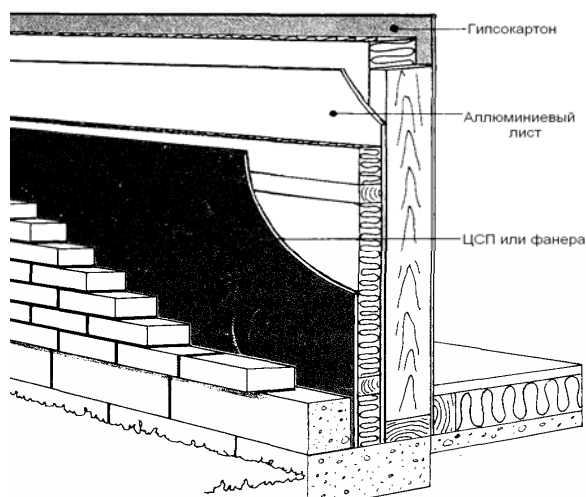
Конструкция стены каркасно-панельного дома, облицованного кирпичом
